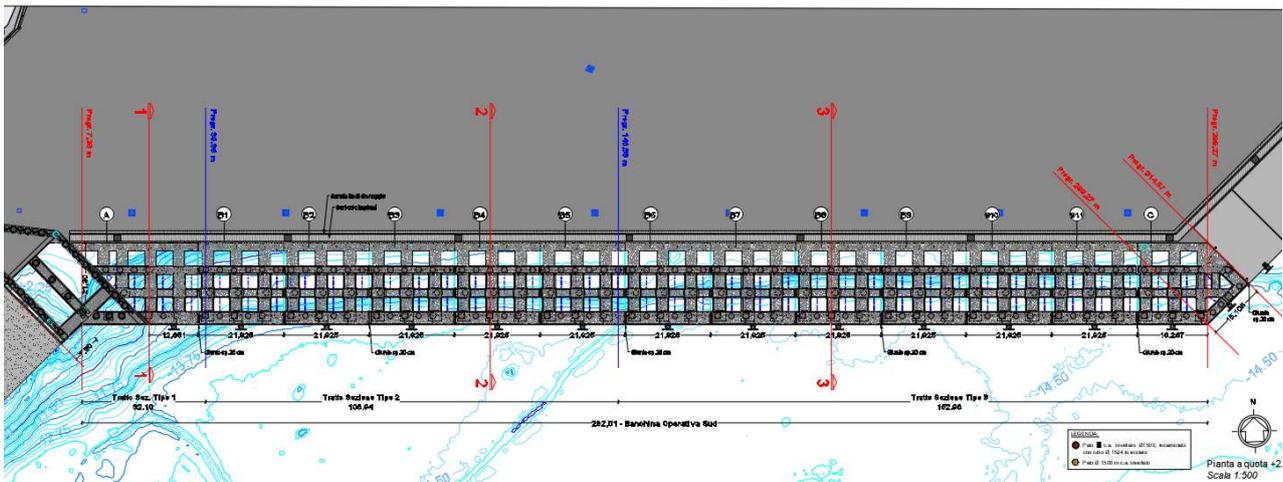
Planimetria strutturale Banchina Operativa Sud
